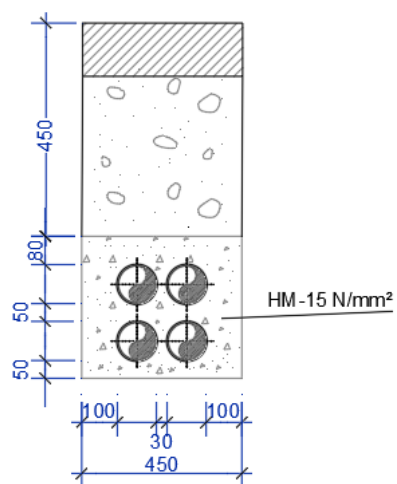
Zanja propuesta tipo 2 (Afectación 02)
